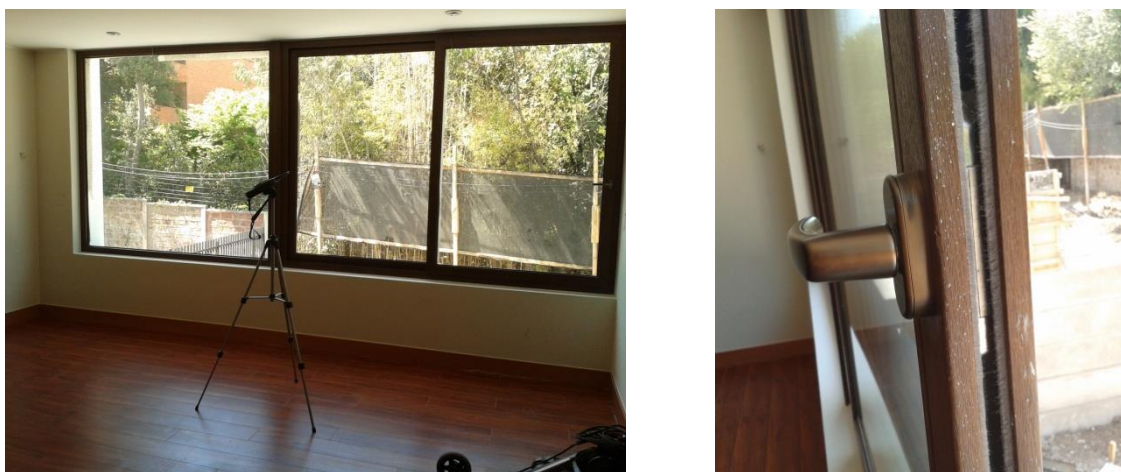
Vista interior de la fachada utilizada para el ensayo y detalle de la terminación de la misma.
